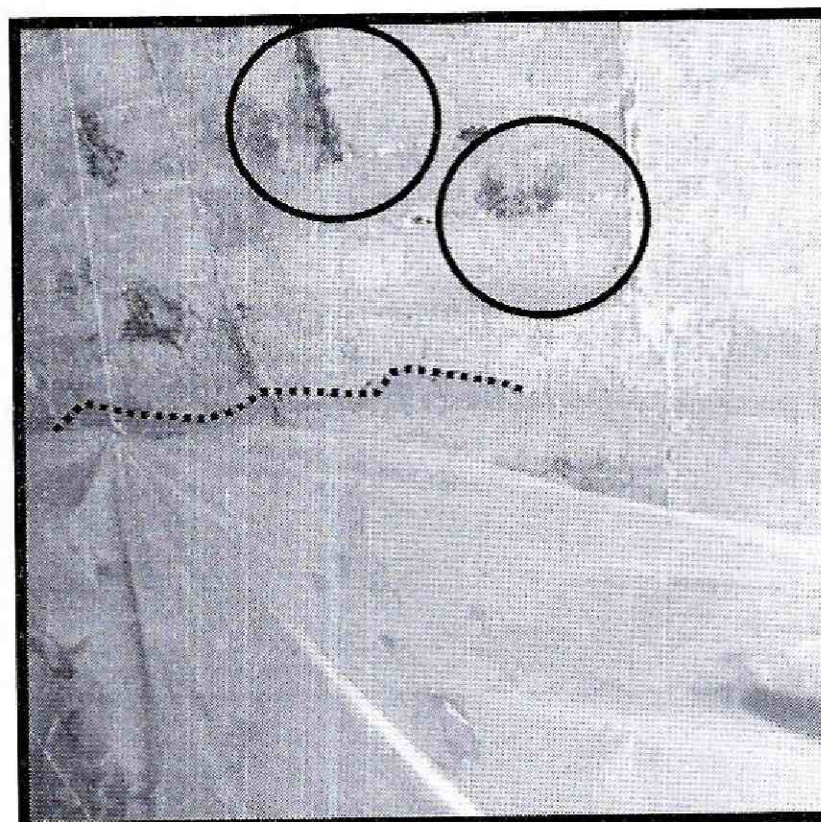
y 11. Aparición de humedades en los muros de mampostería del apartamento 302
